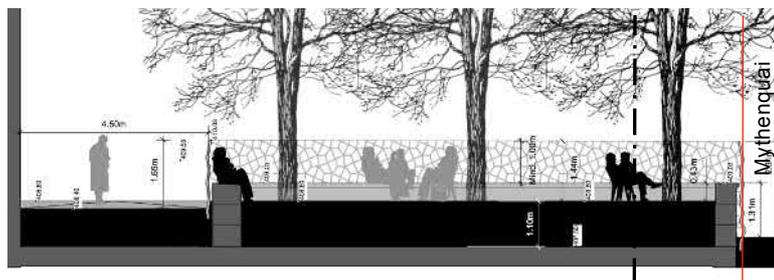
Darstellung Schnitt Seeterrasse / Seegarten, Baulinie (schwarz strichpunktiert, schematische Lage), Grundstücksgrenze (rot)
